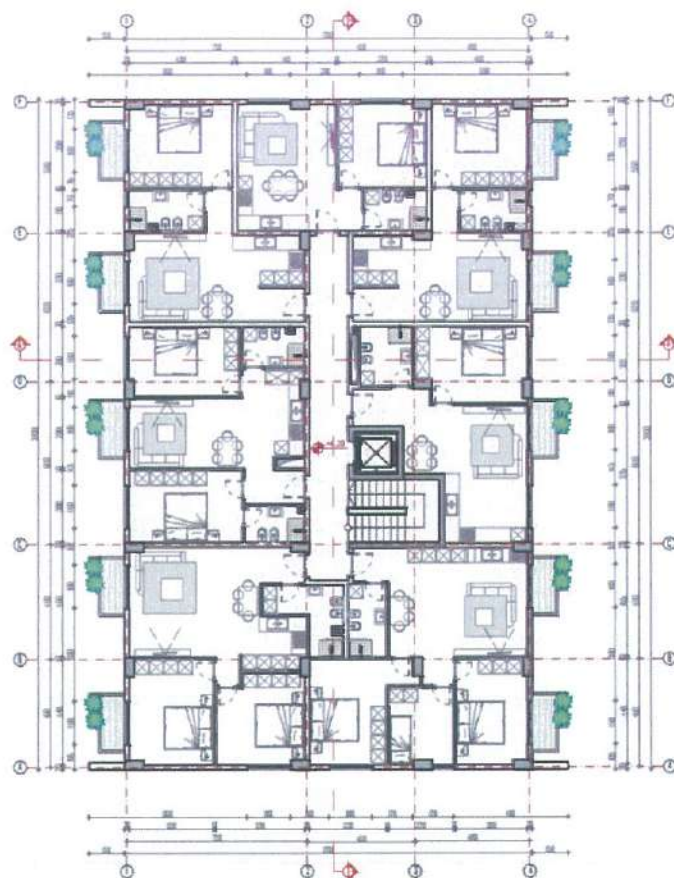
Planimetria e katit të parë, tretë & pestë, objekti 1 & 2
